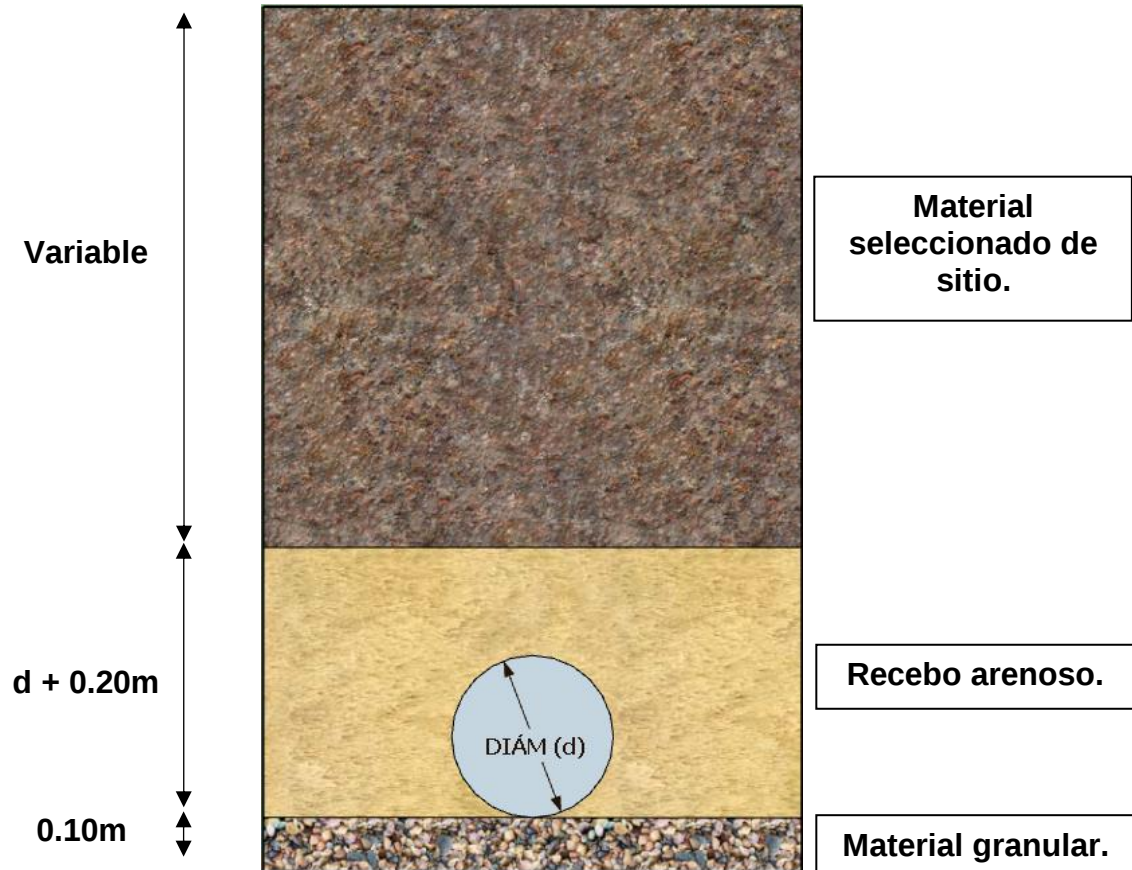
Esquema sección tipo de zanja planteada sobre terreno natural (Zona rural).
